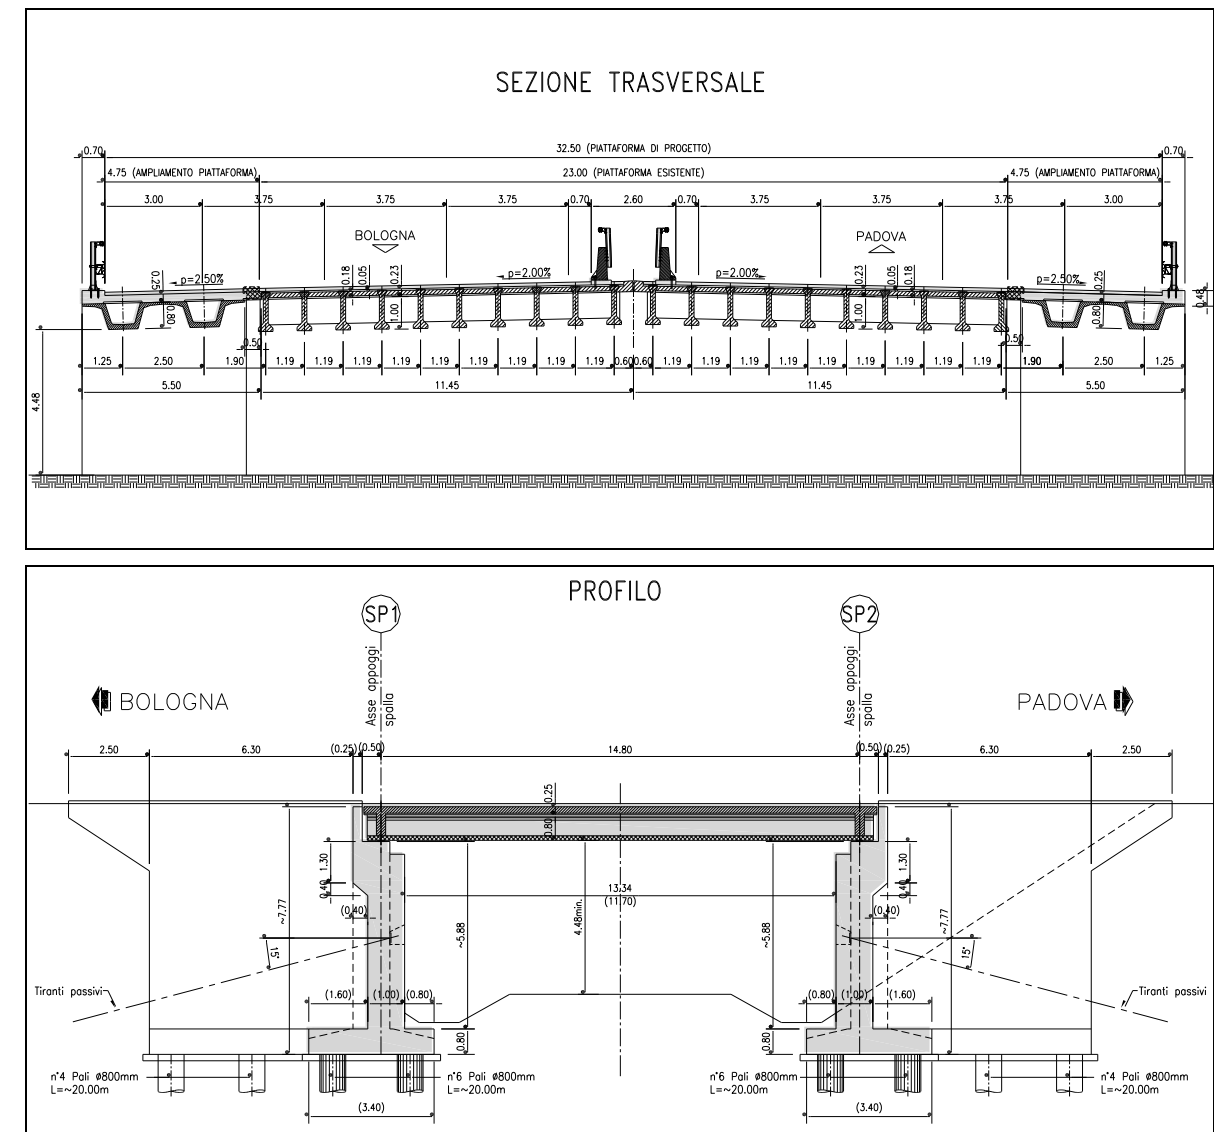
Sezione dell'impalcato e profilo del sottovia della SP 14
